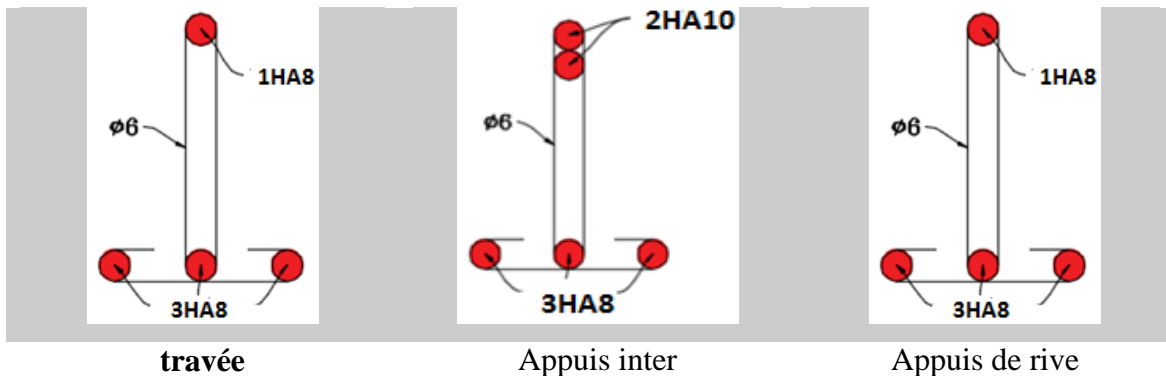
Schémas de ferrailage des poutrelles de la terrasse.
